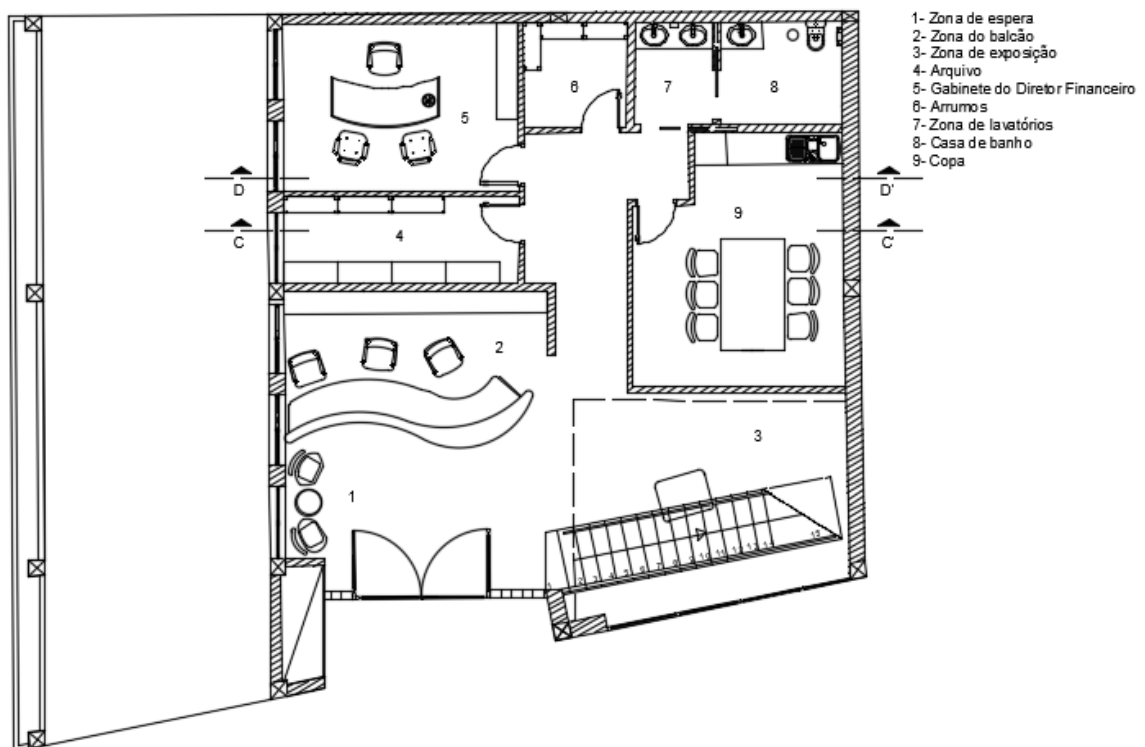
Planta de apresentação do piso 0, em Autocad. Fonte: Ana Cândido.
